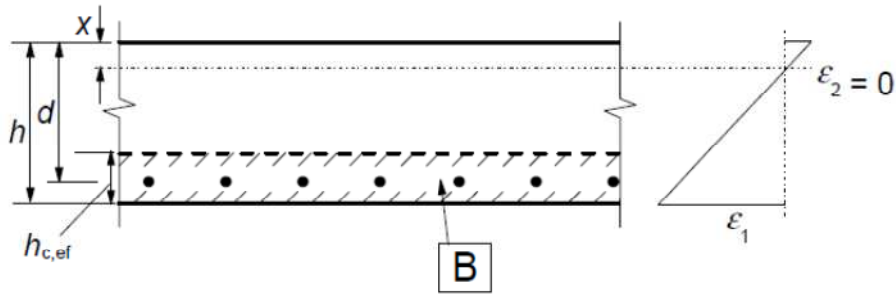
Altura efectiva de betão traccionado numa laje (EN 1992-1-1, 2010).
